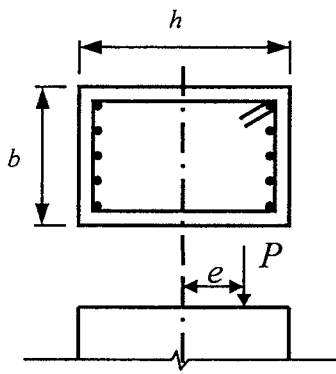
Columna rectangular con refuerzo en dos caras.
